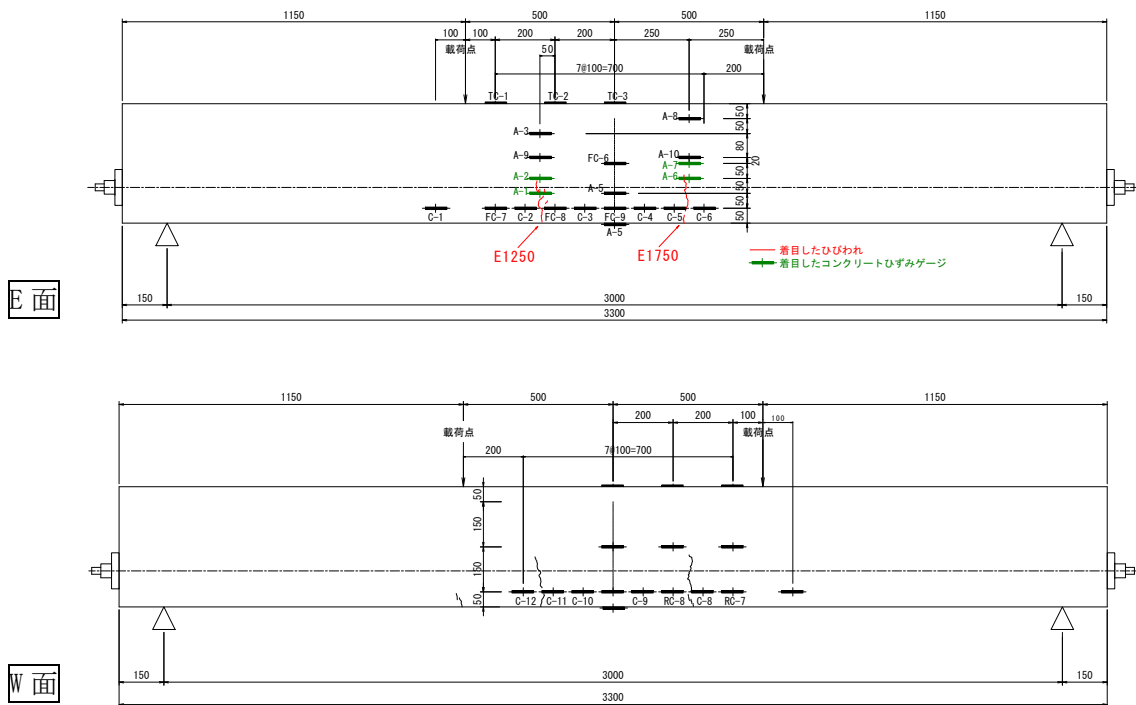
着目したひび割れとひずみゲージ位置 (C46-500)
